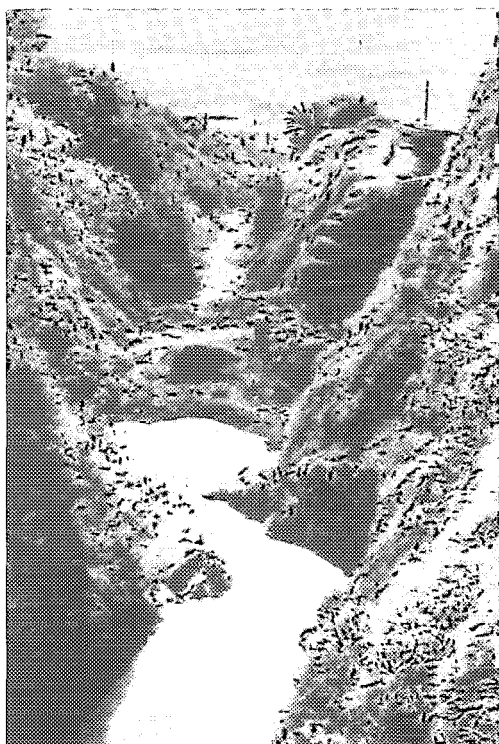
Vue vers l'aval de la prise d'égout, trois semaines après l'accident; une murette provisoire de dérivation en terre a été reconstruite pour mettre hors d'eau les travaux de l'égout. C'est un mur de pierres sèches et de terre, localisé à cet endroit, qui a cédé lors de l'aluvion. (Photo P. PELTRE)
